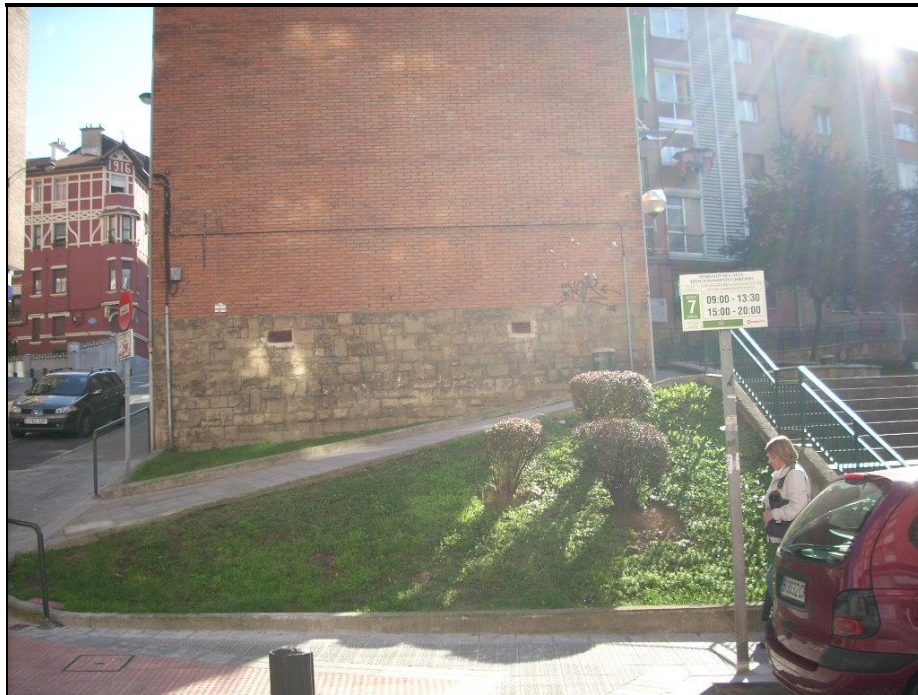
C/ Irala, inmediaciones a la zona donde se proyectan pozos de ventilación y un ascensor.
